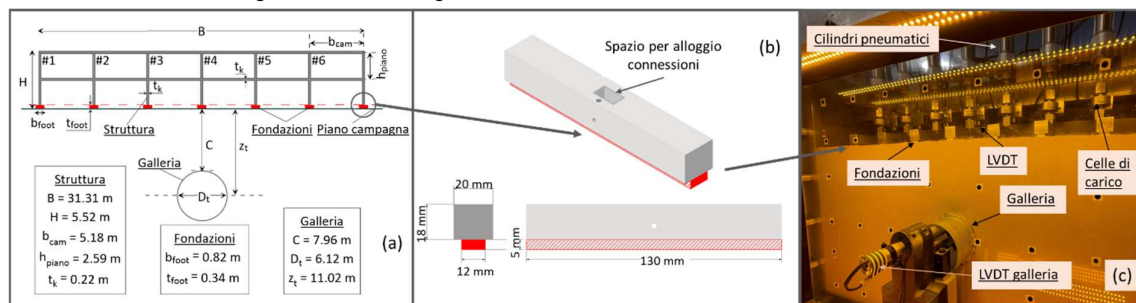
Il problema di interazione terreno-struttura-galleria alla scala del prototipo (a); schema delle fondazioni alla scala del modello (b); vista delle sette fondazioni e della strumentazione in centrifuga (c).
